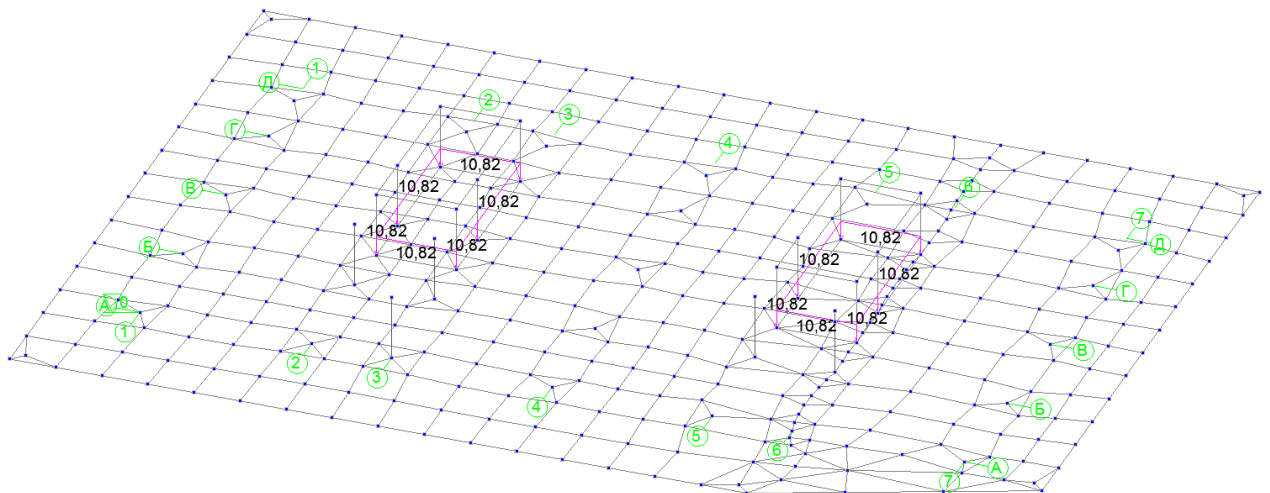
Постоянная нагрузка на фундаментную плиту от лестничной клетки
